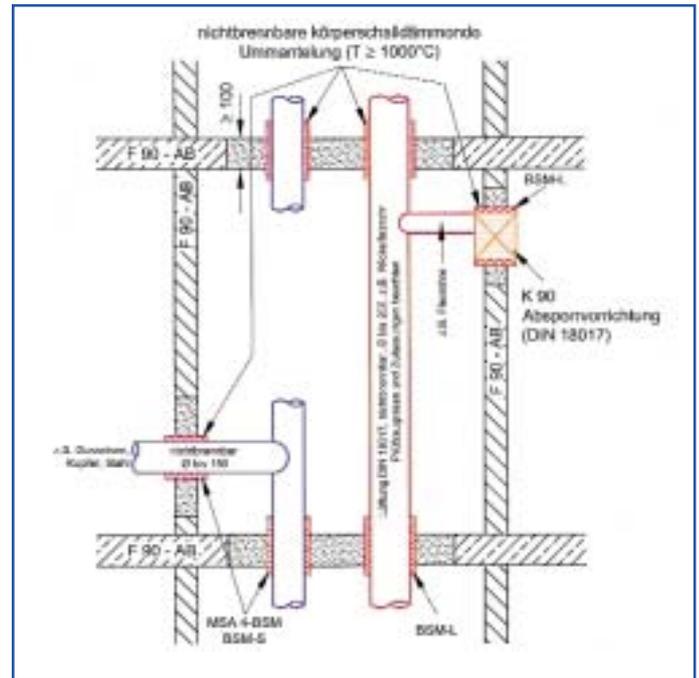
Installation von nicht brennbaren Sanitär-, Heizungs- und Lüftungsleitungen mit nicht brennbaren Dämmungen in einem F90-Installationsschacht nach DIN 4102, Teil 4
